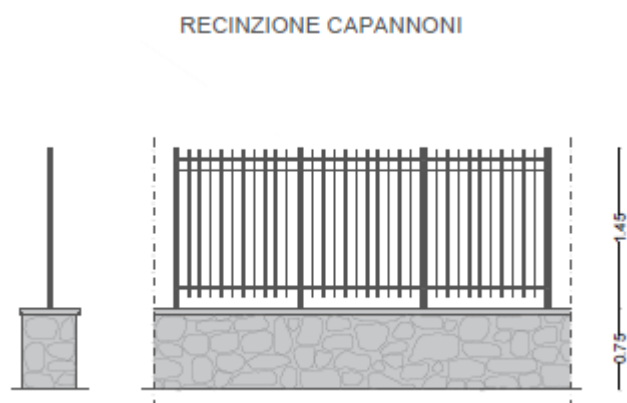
Prospetto muretti a secco di delimitazione lotti
